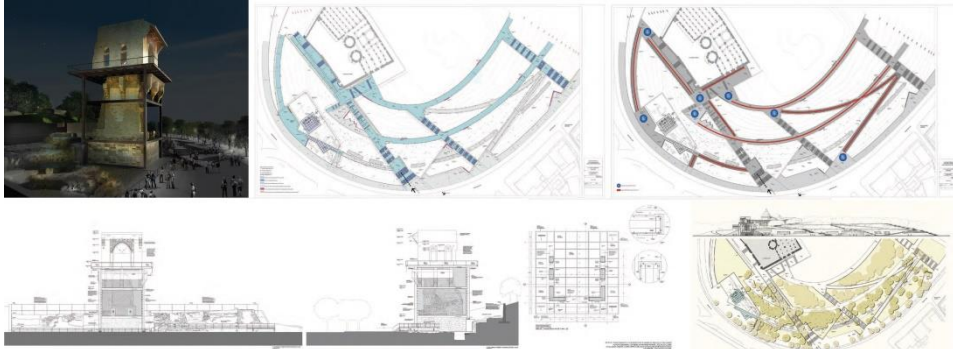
II. Kılıçaslan Köşkünün beton şemsiye altında korunması (Url-1)
